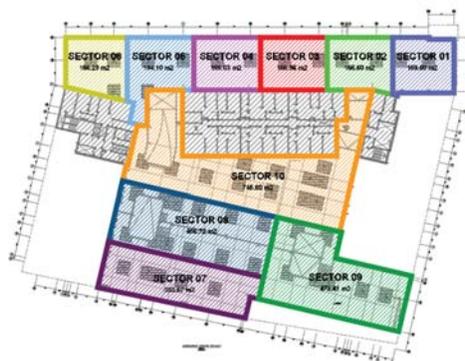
Sectorización de estructuras de sótanos 02 y 01. Fuente: Elaboración
